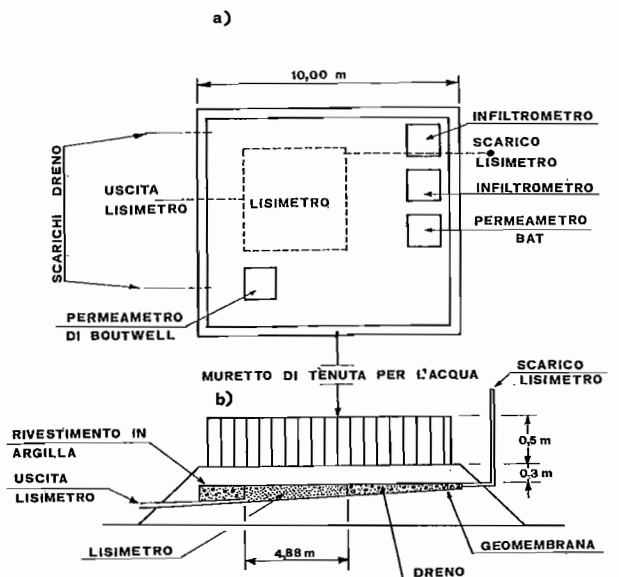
Pianta e sezione schematica dei rilevati con disposizione degli apparecchi di misura.
